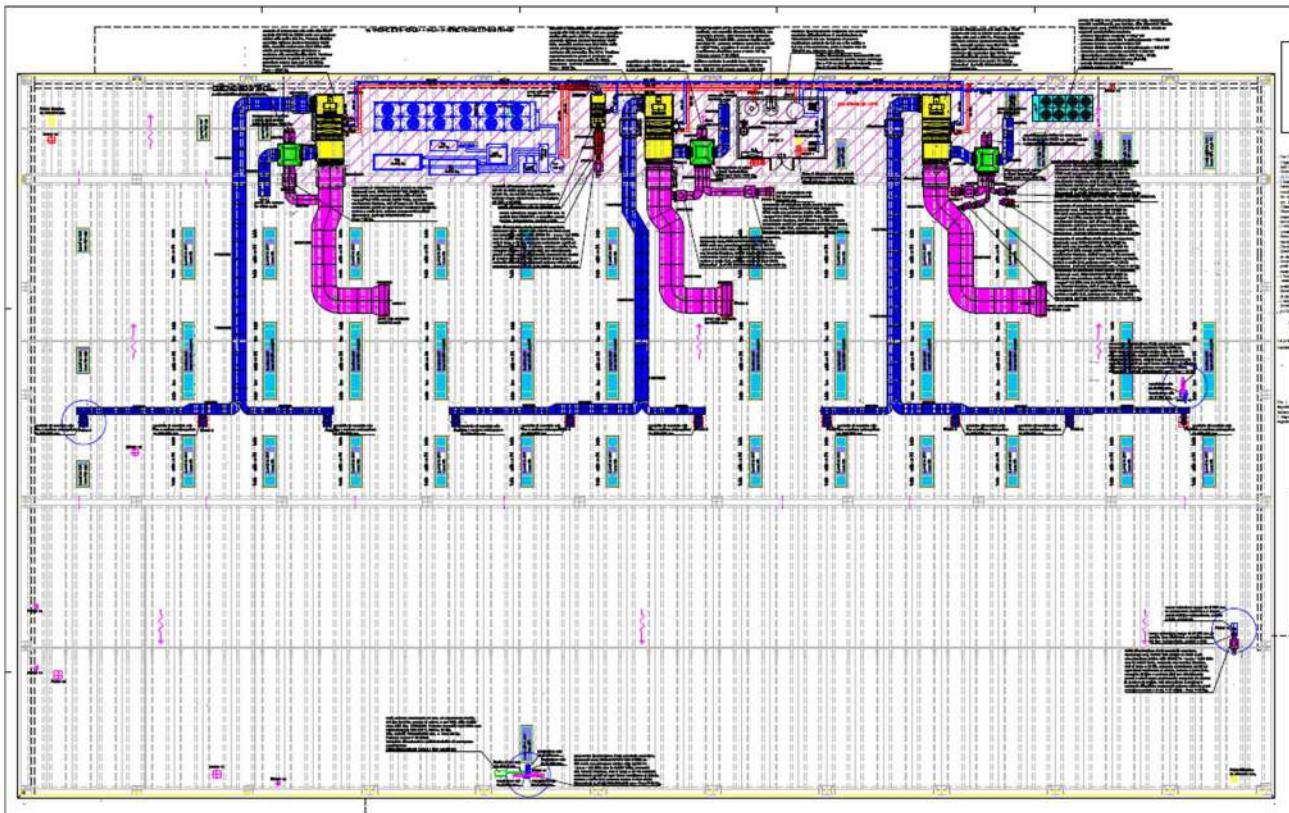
vista planimetrica impianti futuri con posizionamento in copertura (riscaldamento, raffrescamento, etc.).
